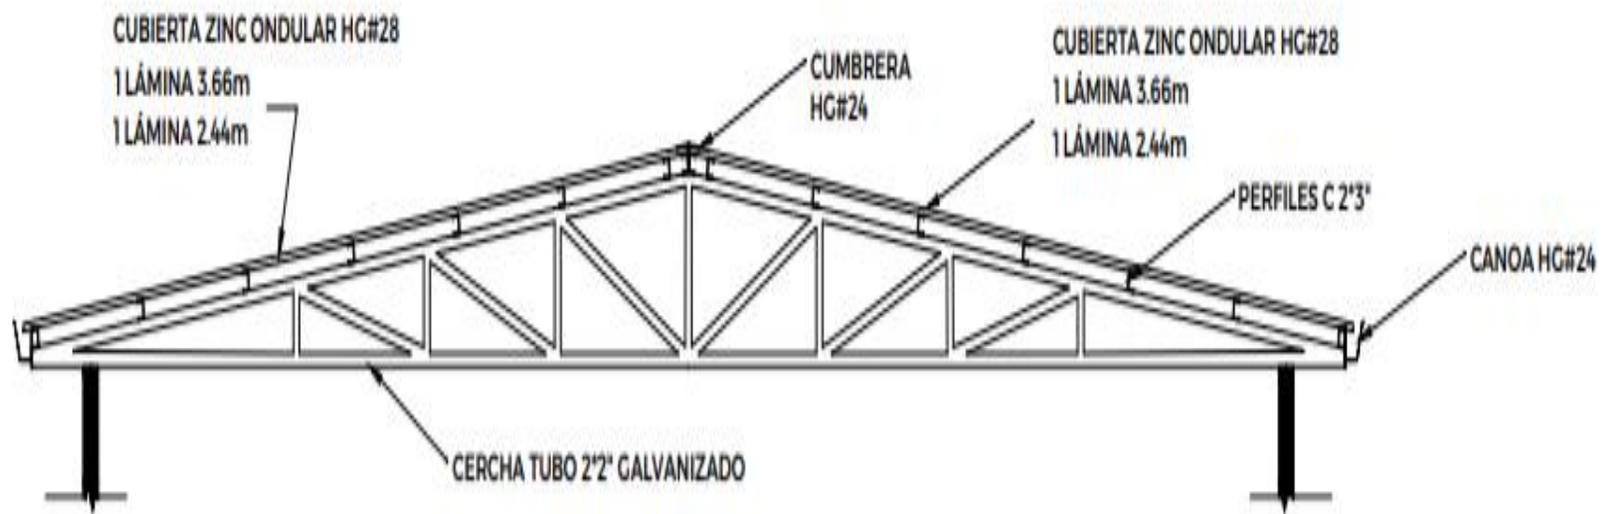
Planta de techos 2 aguas - Sistema constructivo TeknoBlock- lamina convencional
